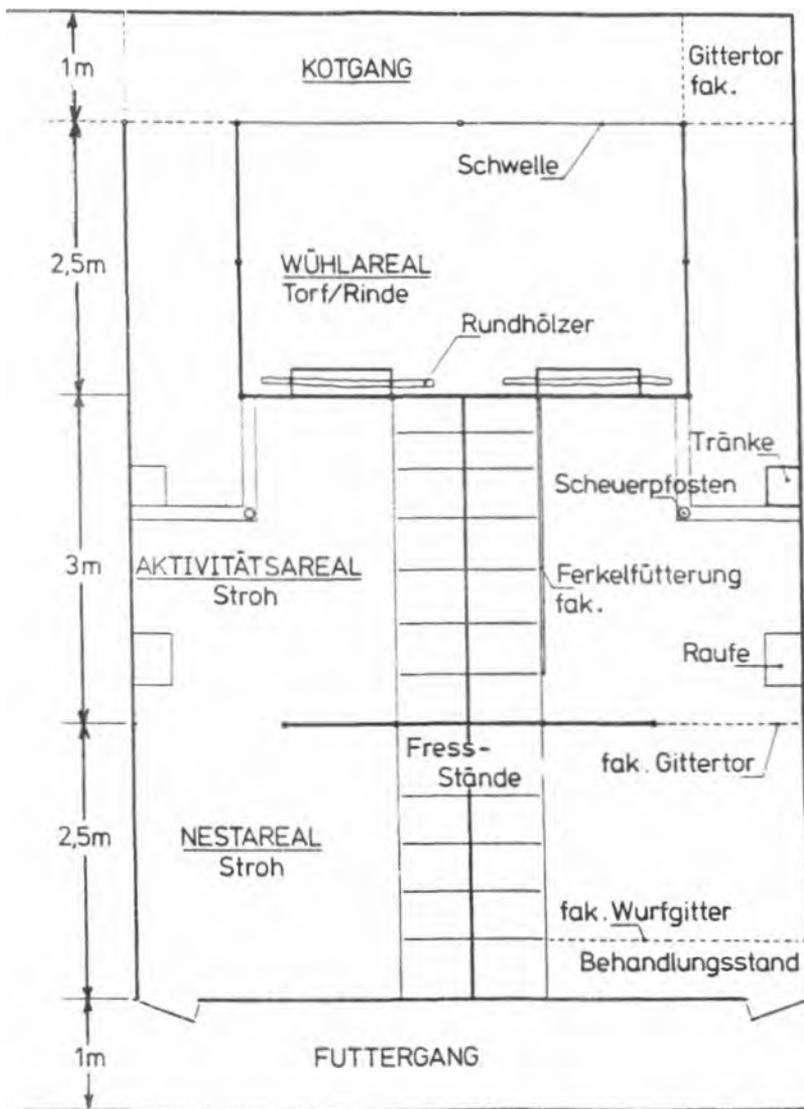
Grundriß und Ausstattung des möblierten Familienstalls (M), zwei Buchten. Offene Gebäudefront am Kotgang
